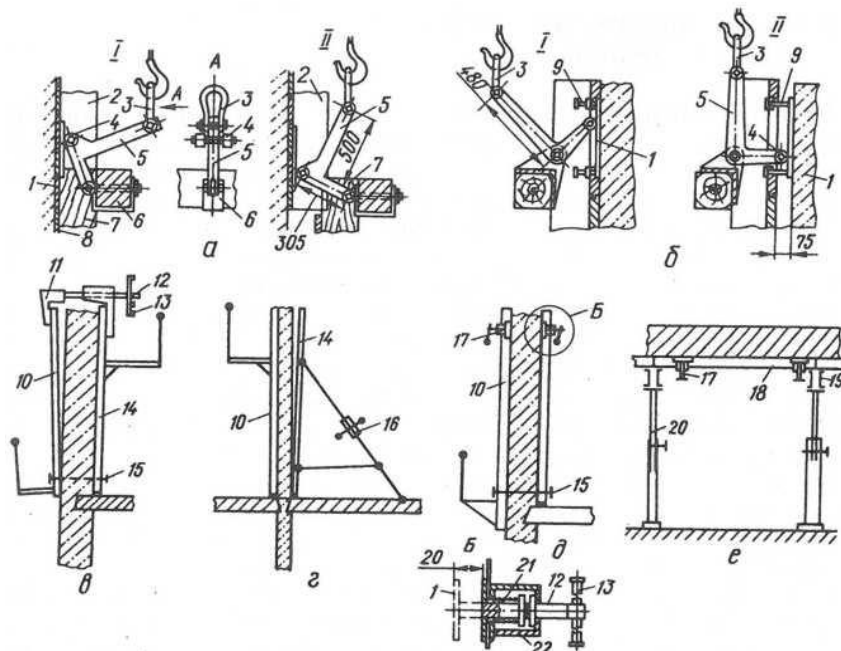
Схеми розбирання великощитової опалубки:
